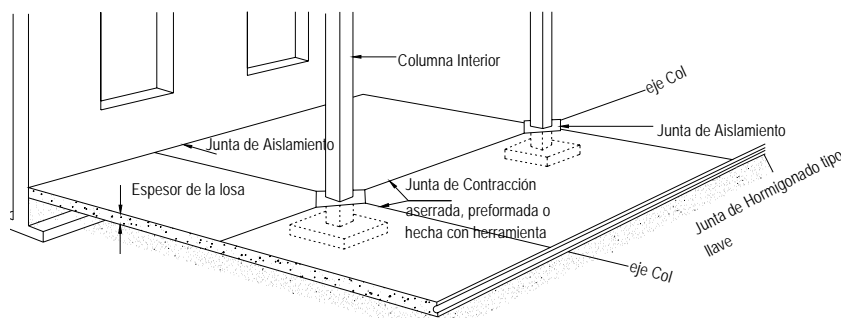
Ubicación y tipos de juntas en una losa de Hormigón.
